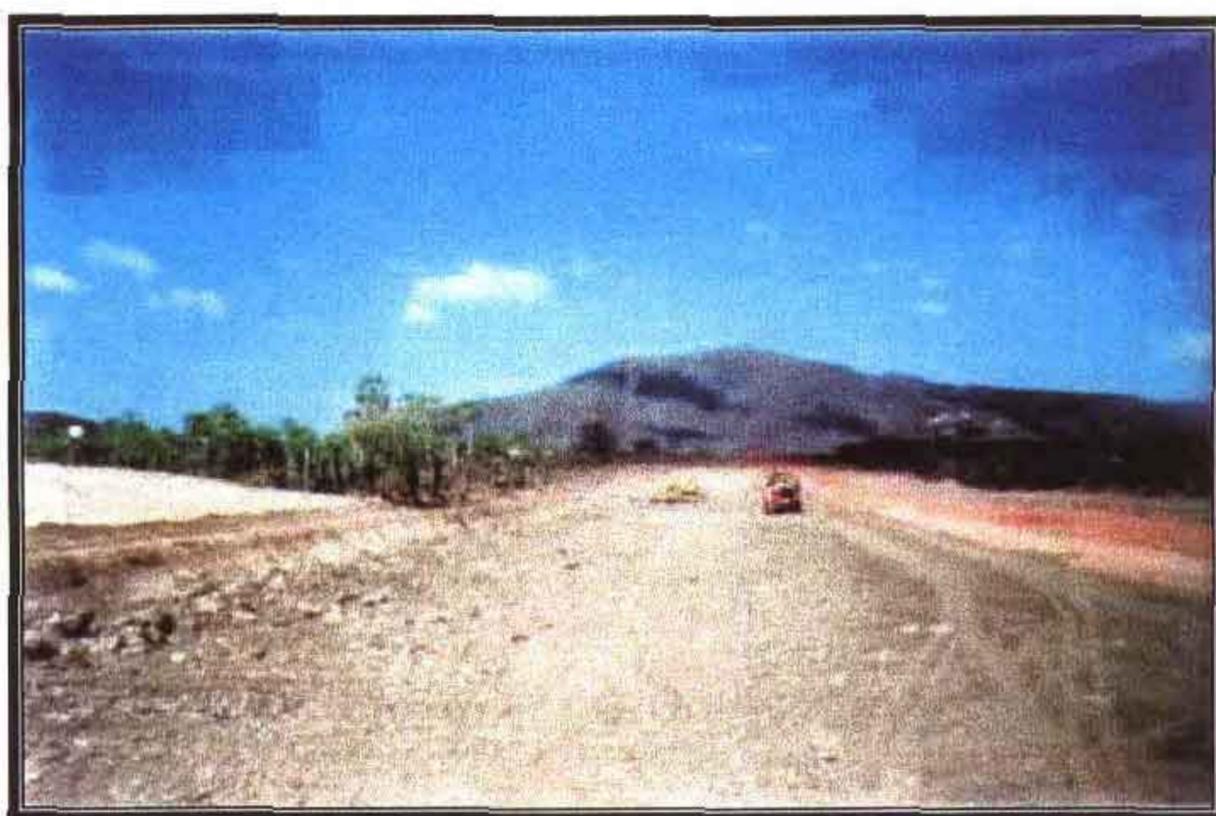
Lançamento e espalhamento do enrocamento de jusante.
